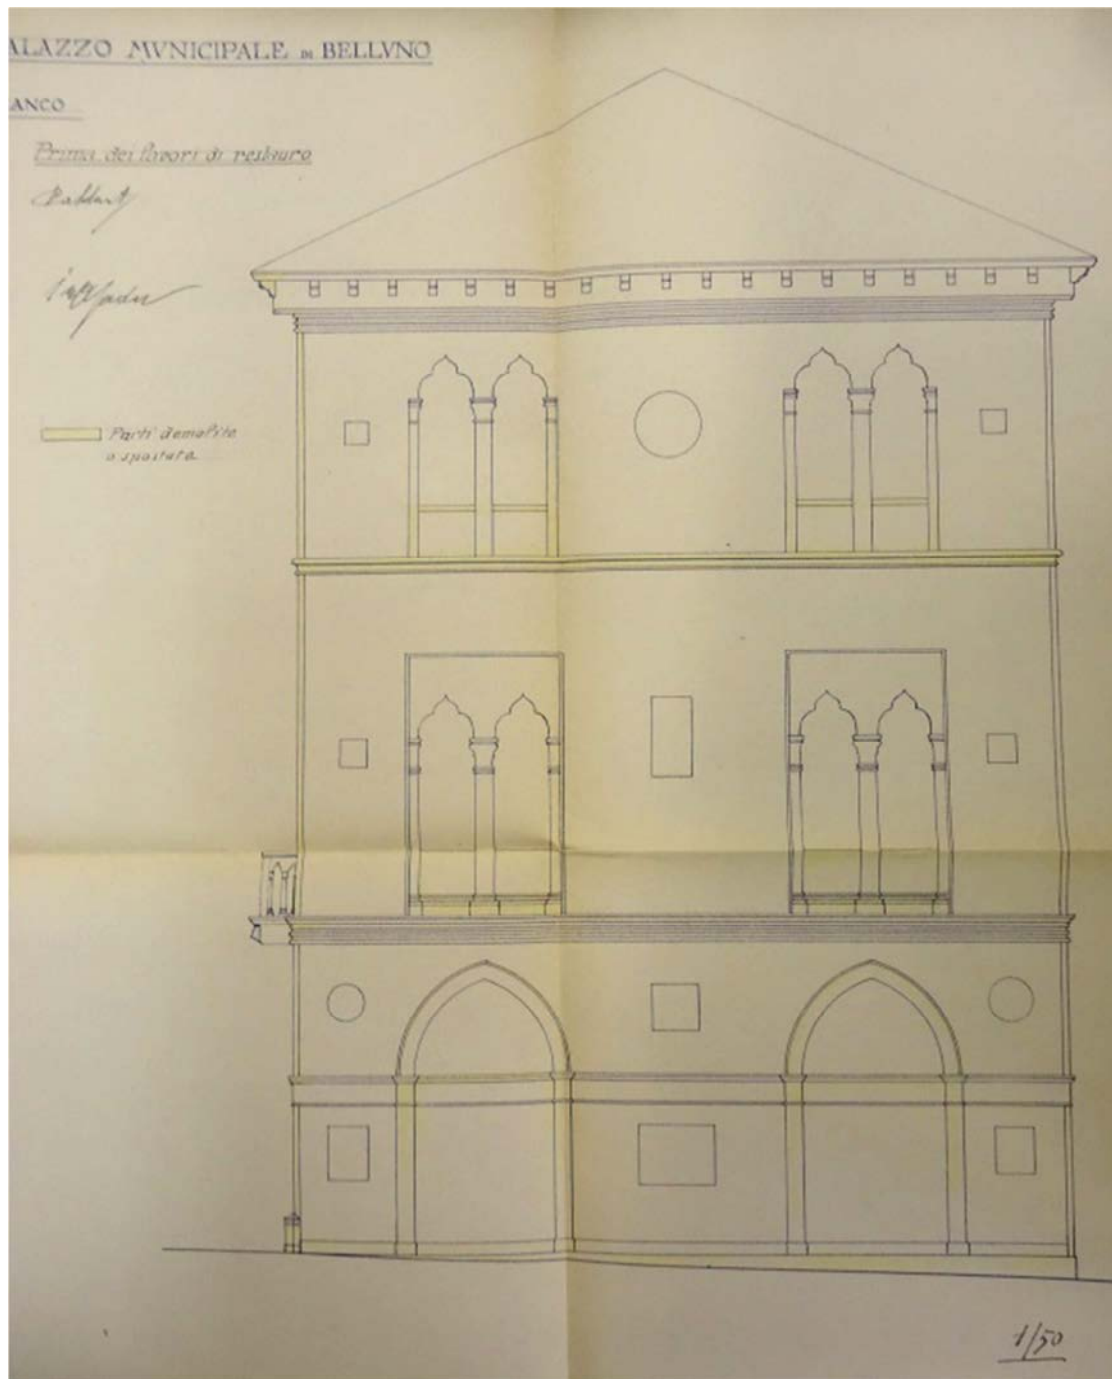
Prospetto laterale, progetto di restauro delle facciate, disegno, 1931 (ASCB).
